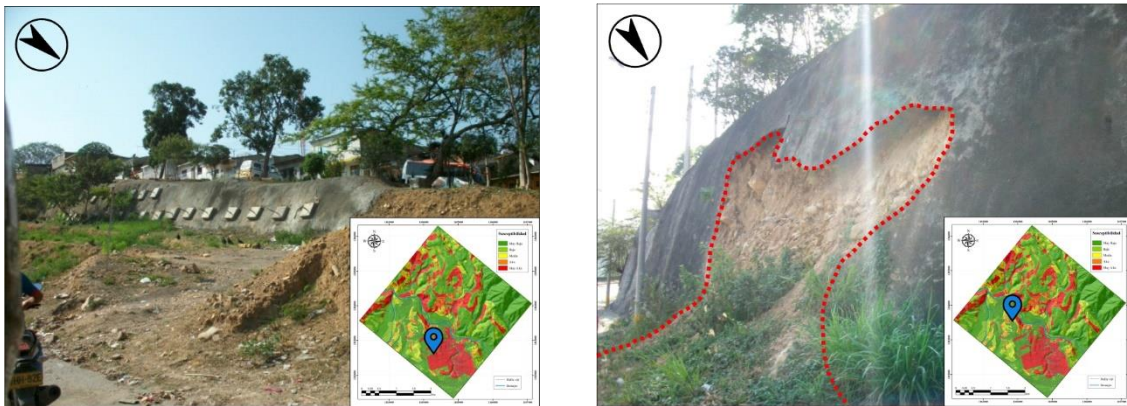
Estructura de contención sobre laderas inestables localizadas en la entrada del barrio Kennedy [Izq]. Talud con obra de estabilización colapsada en la vía que comunica al sector de la planta de Bavaria y el barrio Kennedy [Der].
